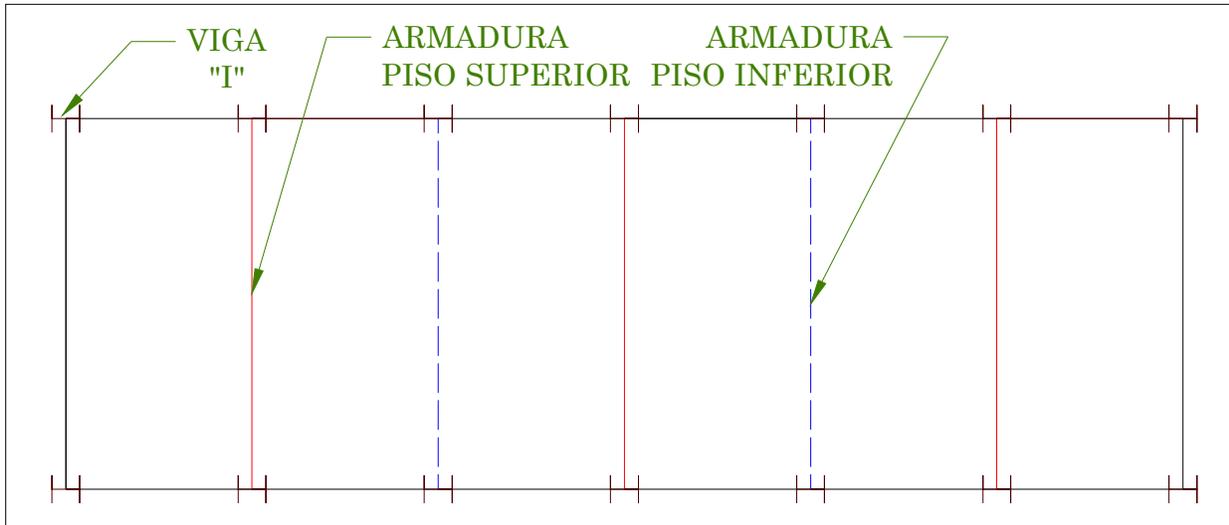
Vista en planta del sistema de armaduras alternadas
